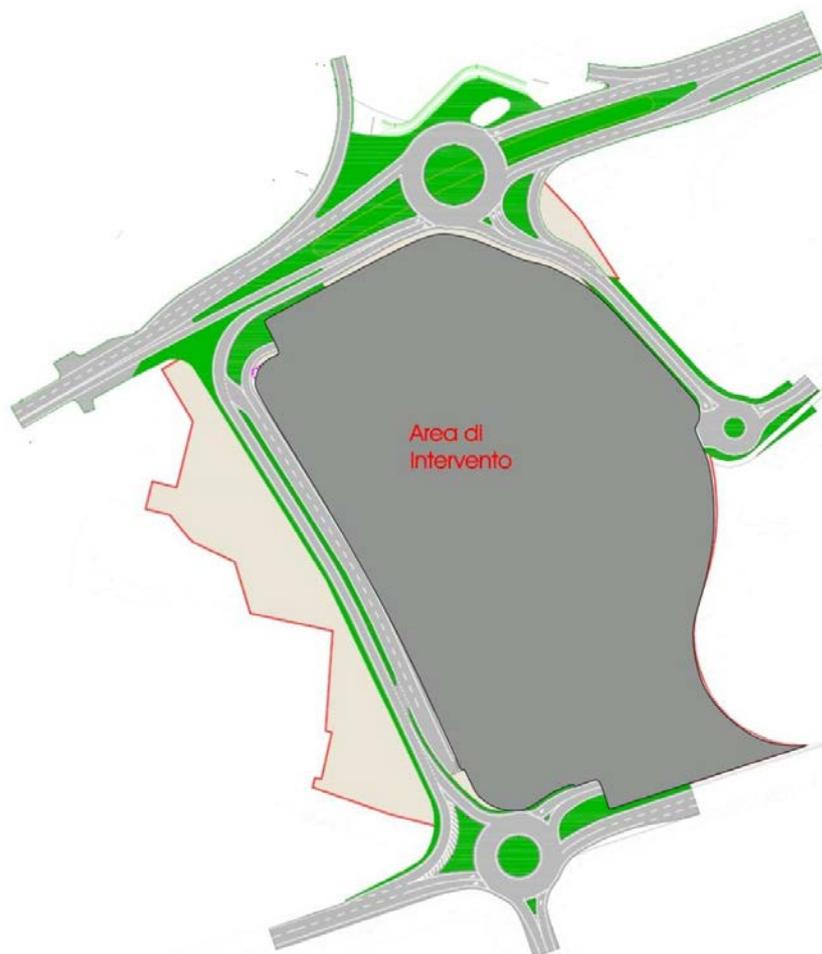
Interventi viabilistici previsti – Ipotesi 2 – Planimetria di progetto
